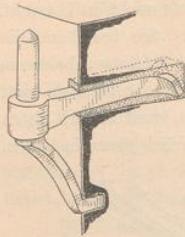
Beschlag. Stützhaken zum Eingipsen oder Einleien in Sandstein.
